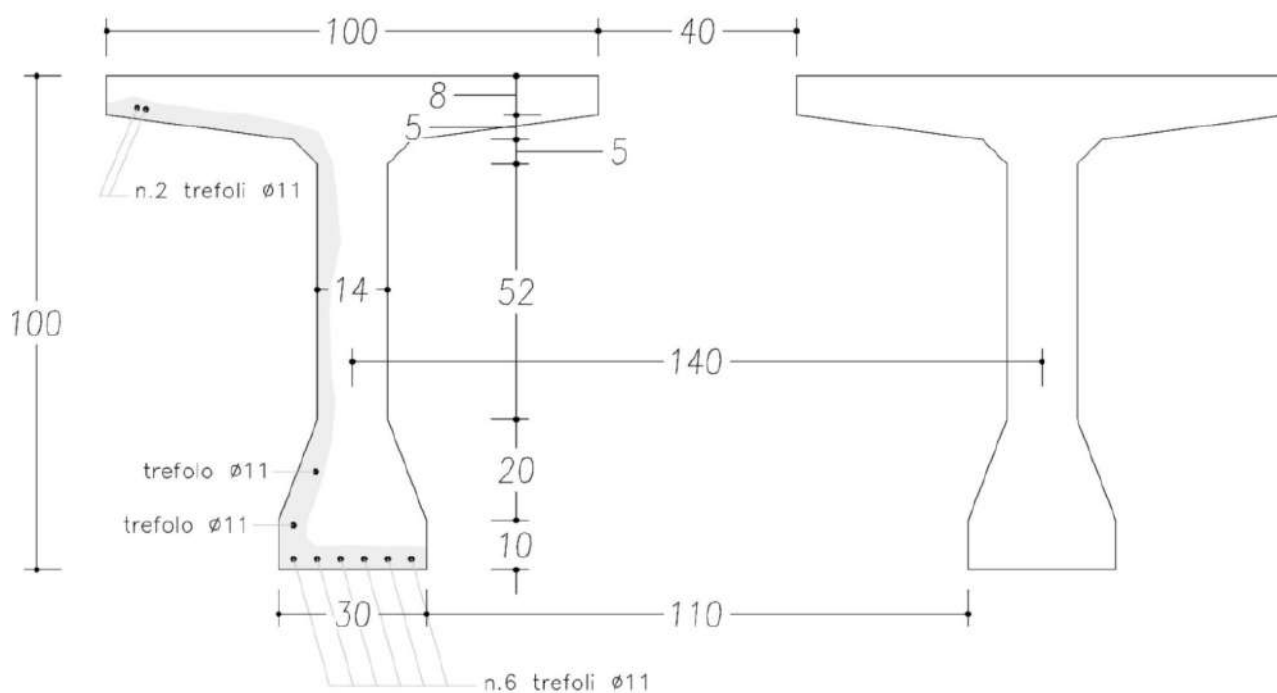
SEZIONE IN CAMPATA CON TREFOLI DA PRECOMPRESSIONE
